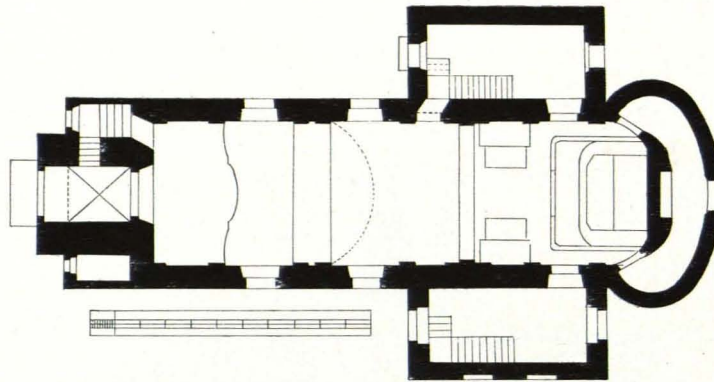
Elsbethen, Kuratfiliakirche, Grundriß 1 : 300 (S. 48)
